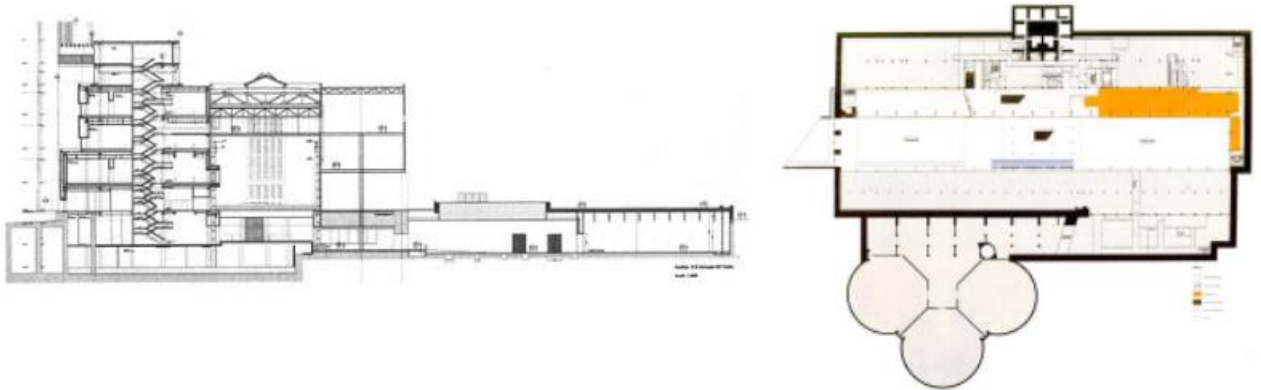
Corte longitudinal y planta. Fuente: Plataforma Arquitectura
